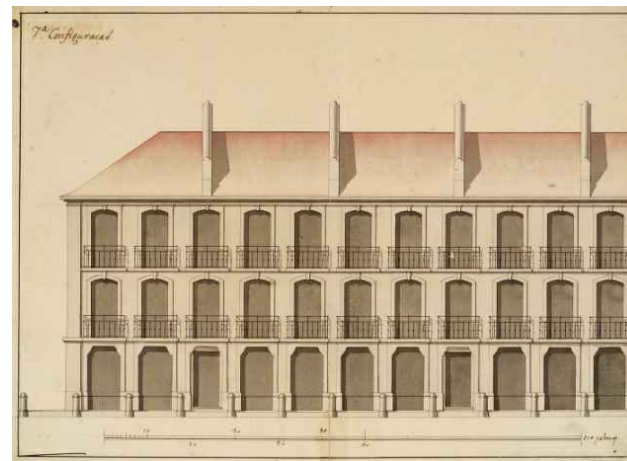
Fachada - 7ª Configuración (MC. DES. 1081).
